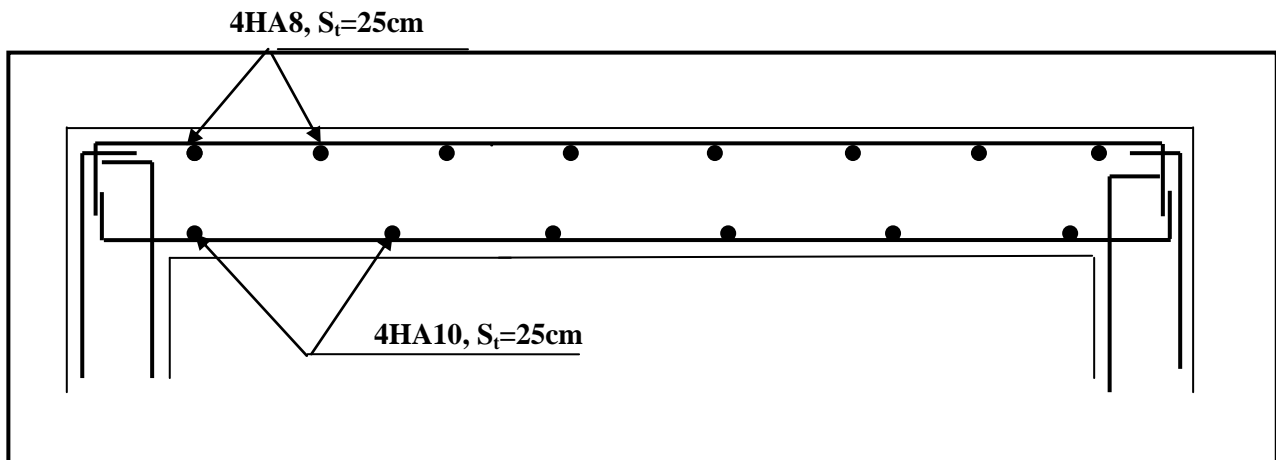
Plan de ferrailage de la salle machine suivant x-x
